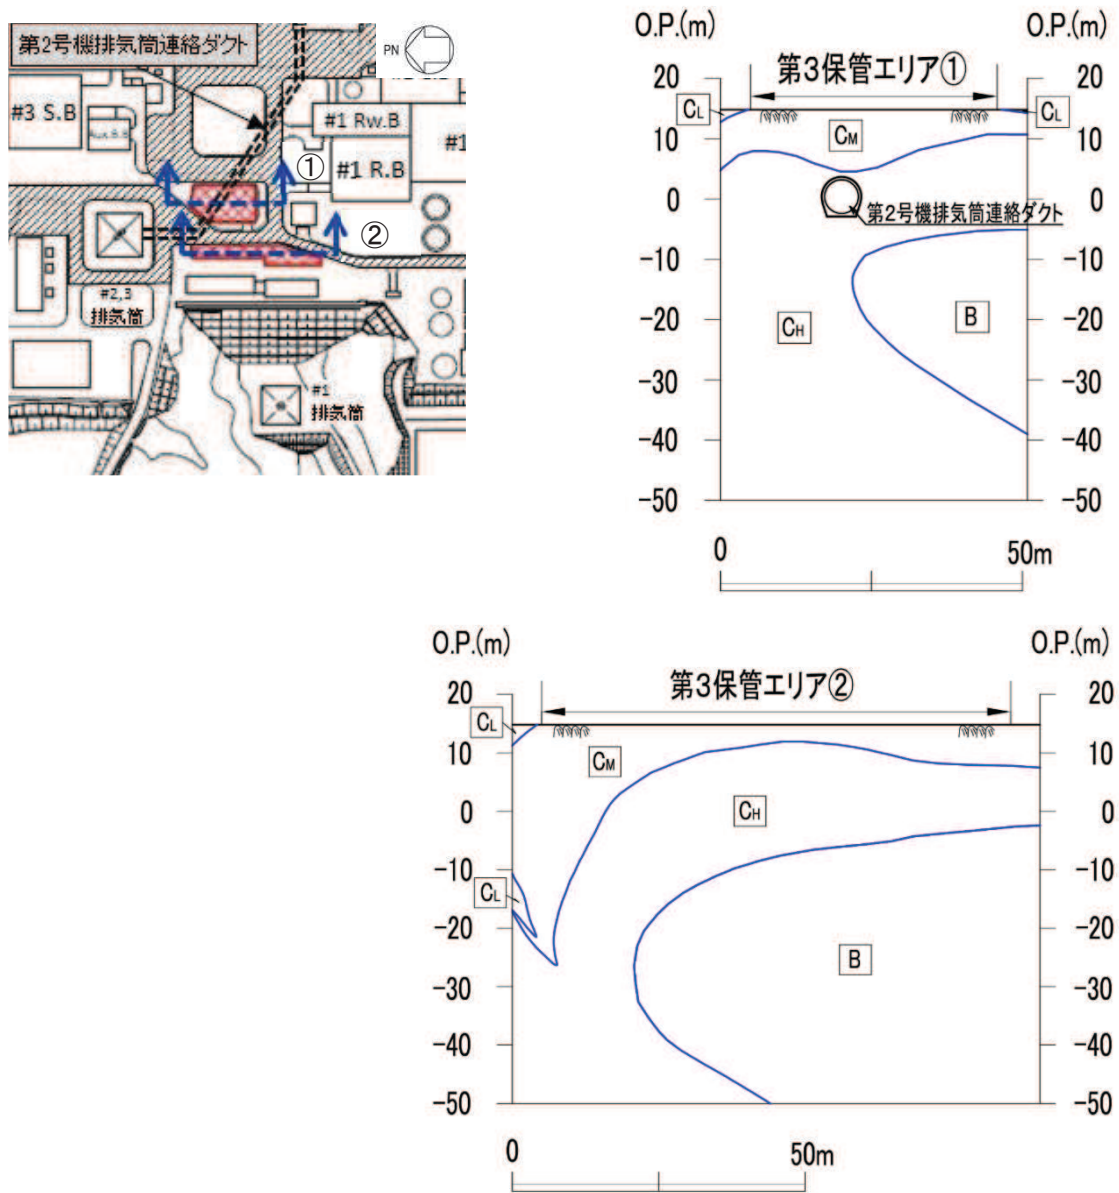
第3保管エリアの平面図及び地質断面図
